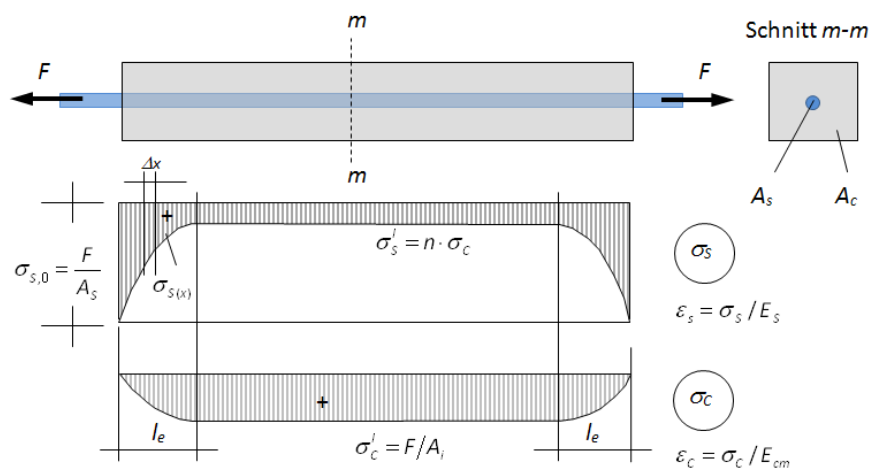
Spannungen zwischen Beton und Betonstahl im Zustand I
